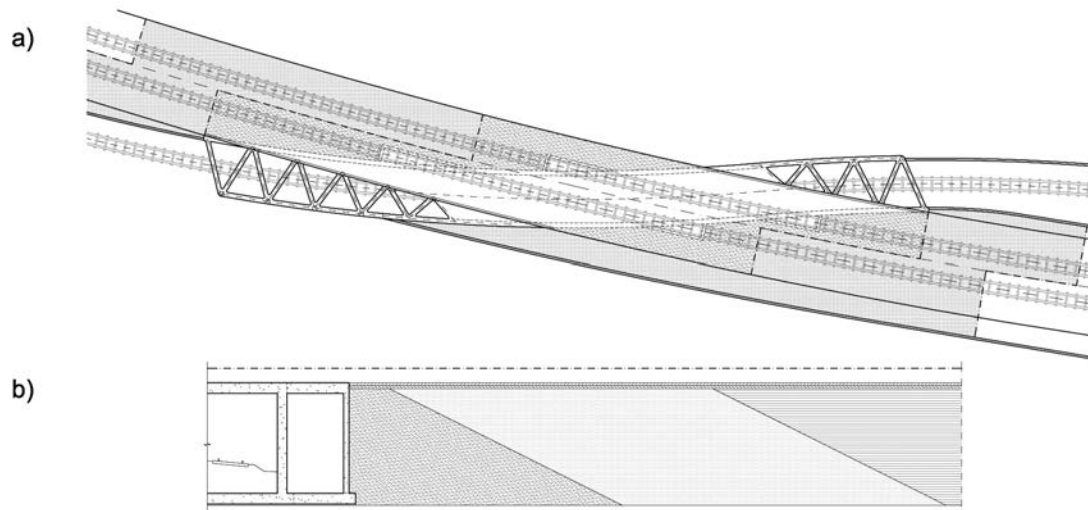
Cuñas de transición en la pérgola en la L.A.V. Córdoba-Málaga en Málaga; a) Planta; b) Sección longitudinal
